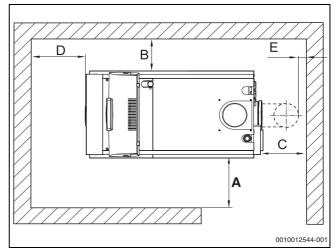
Distanze dalle pareti nel locale di posa (versione destra)
